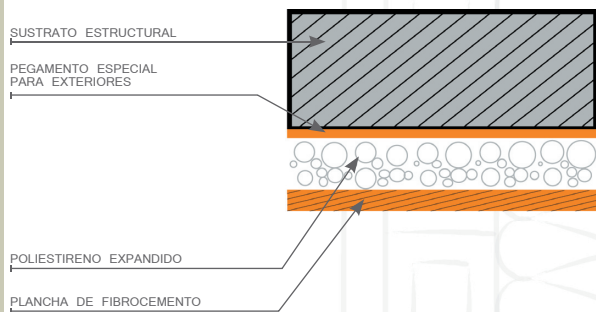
w: Esquema de solución FNV-PC con plancha de EPS y placa de fibrocemento (vista corte horizontal).
